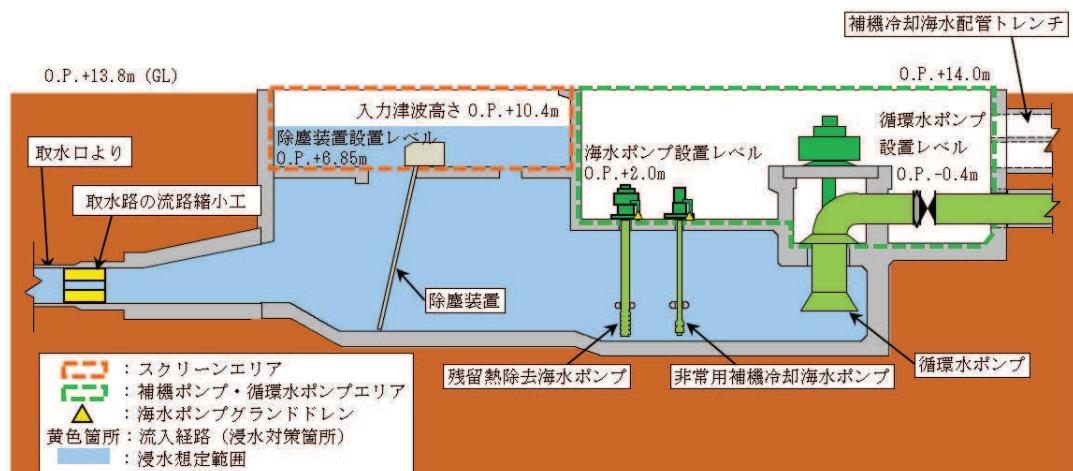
第 1 号機 海水ポンプ室 浸水対策配置図（A-A 断面図）
